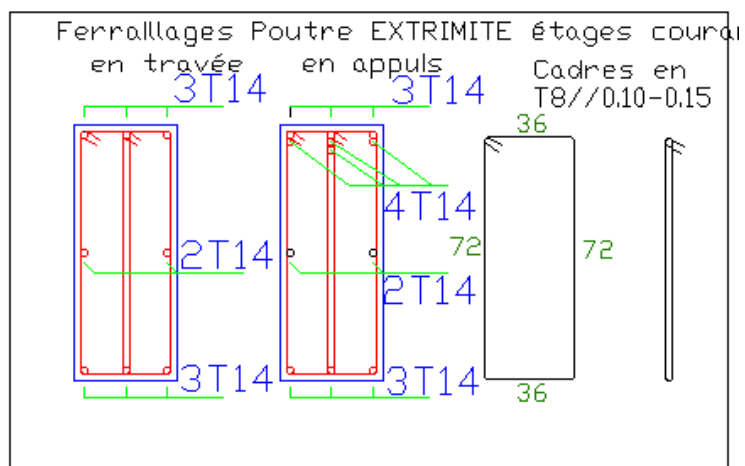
Schémas de ferrailage des poutres (40 x 80) cm²
